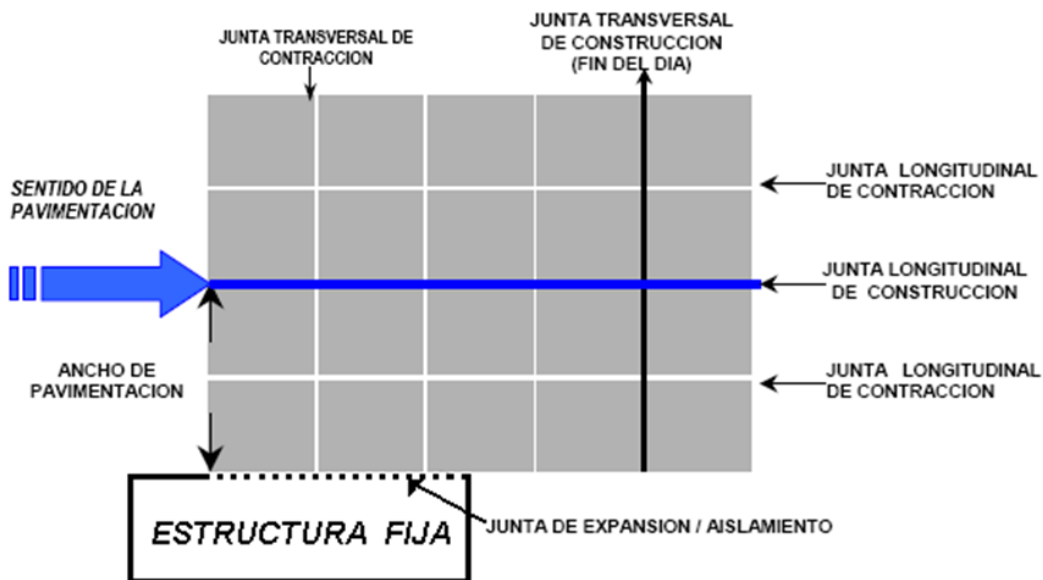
Tipos de juntas en un pavimento rígido visto en planta.
